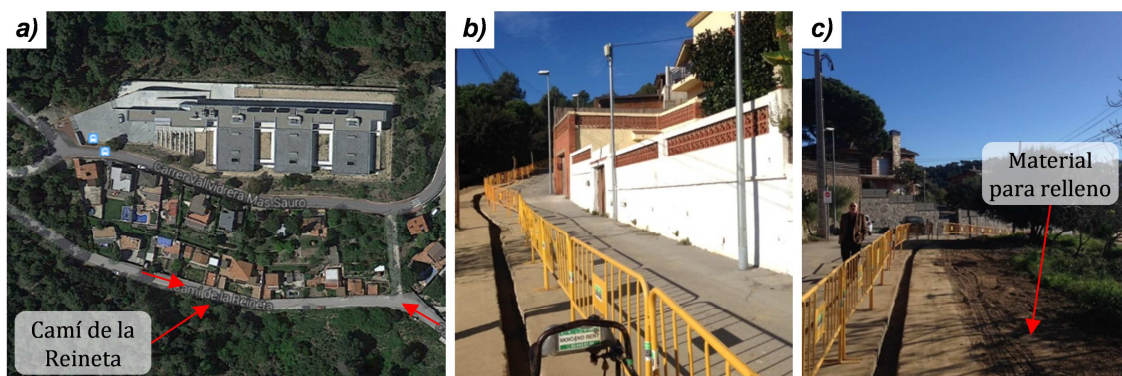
116 – a) localización de la zanja; b) y c) detalle de la zanja
